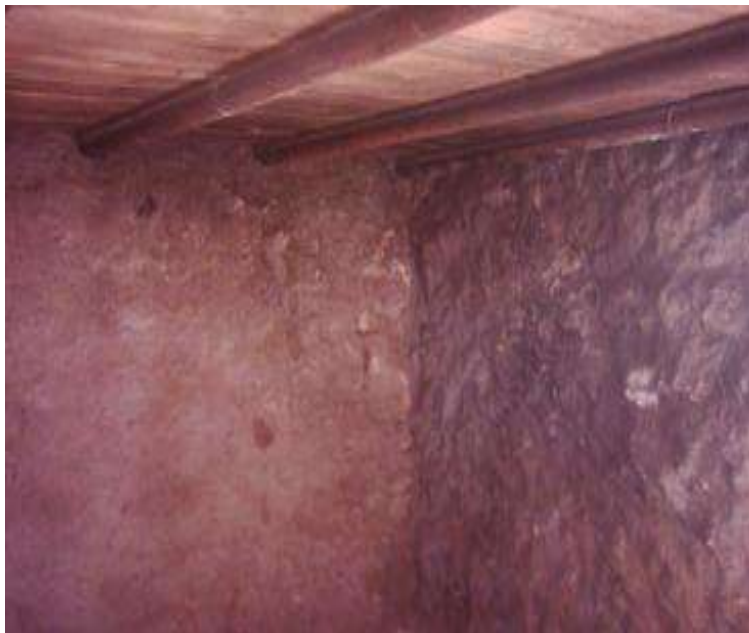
mixité des matériaux de construction de l'habitat précaire (Source : Sofrani K janvier 2009)
